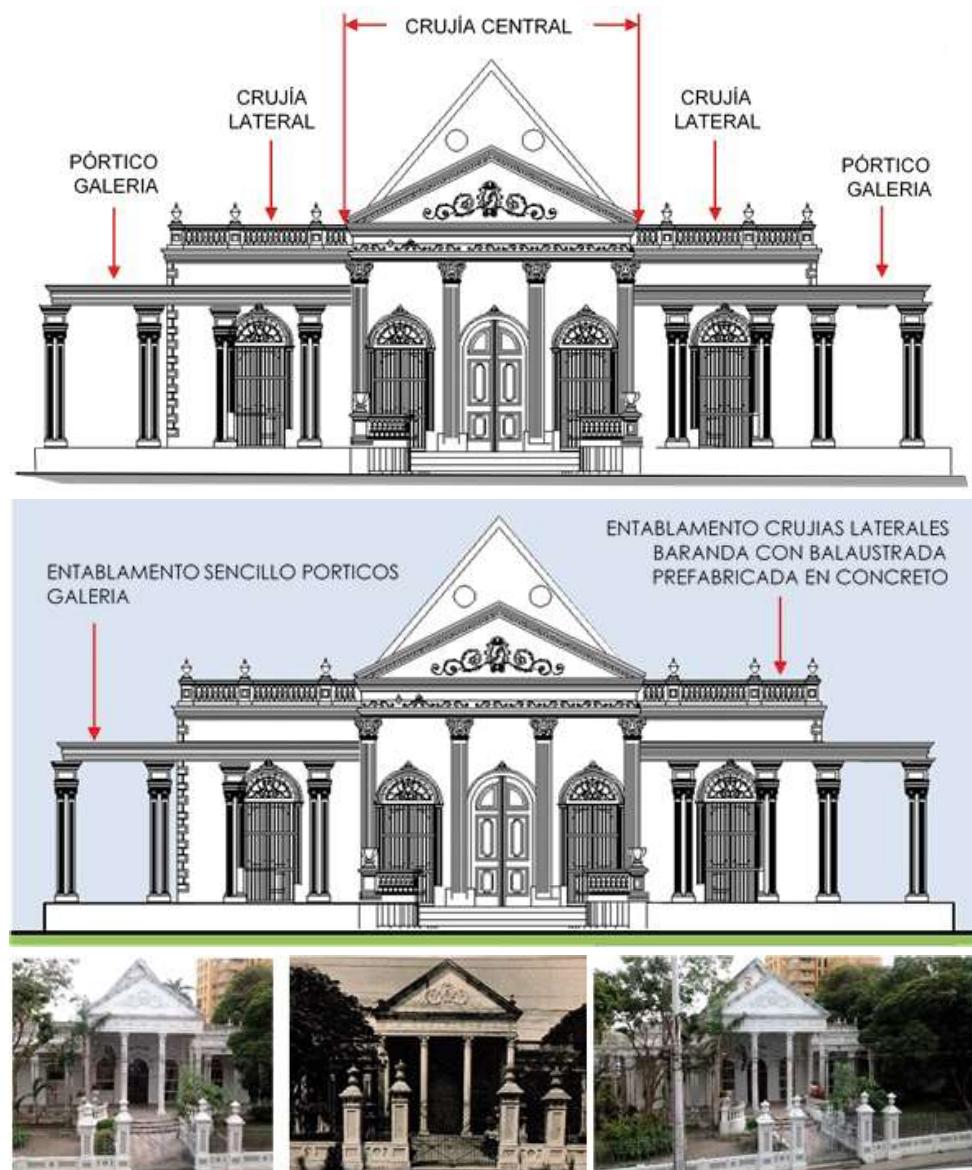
Planos Fachada Principal casa Villa Susana dibujada en AutoCAD, ambientada y Fotografías de la fachada. Fuente: Archivo del autor. 2015. Sección transversal por el pórtico central - detalles
